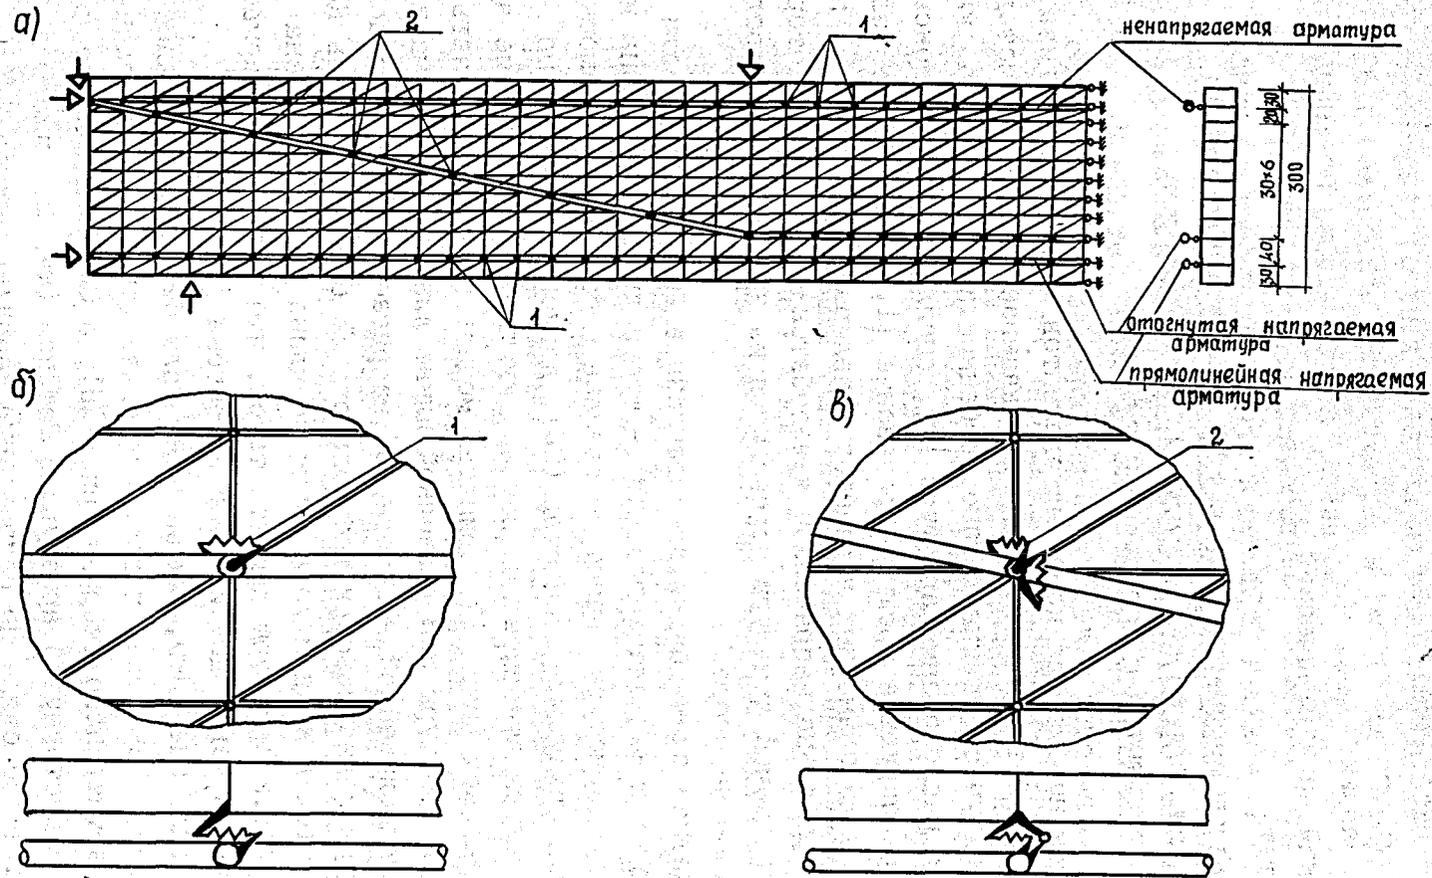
Рис. I. Расчетная схема железобетонной балки с отогнутой арматурой
